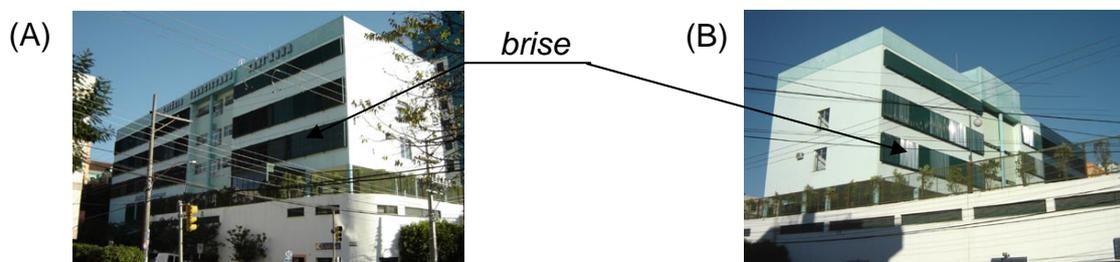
Vista externa - (A) fachada Leste (B) fachada Oeste
